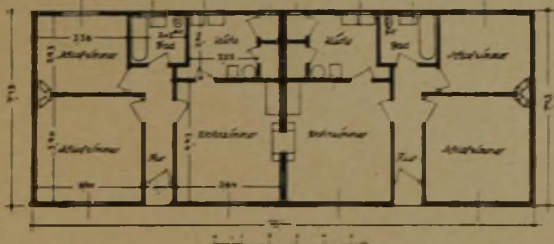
Grundriß. (Weir-House, Eastwood-Type.)
